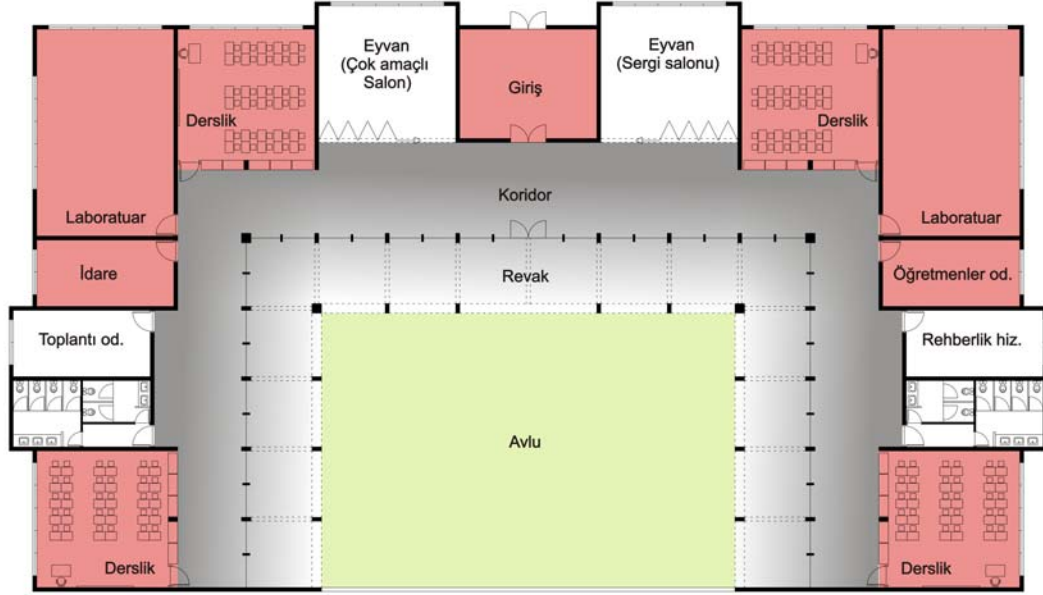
İki derslikli ilköğretim okulu plan şeması
